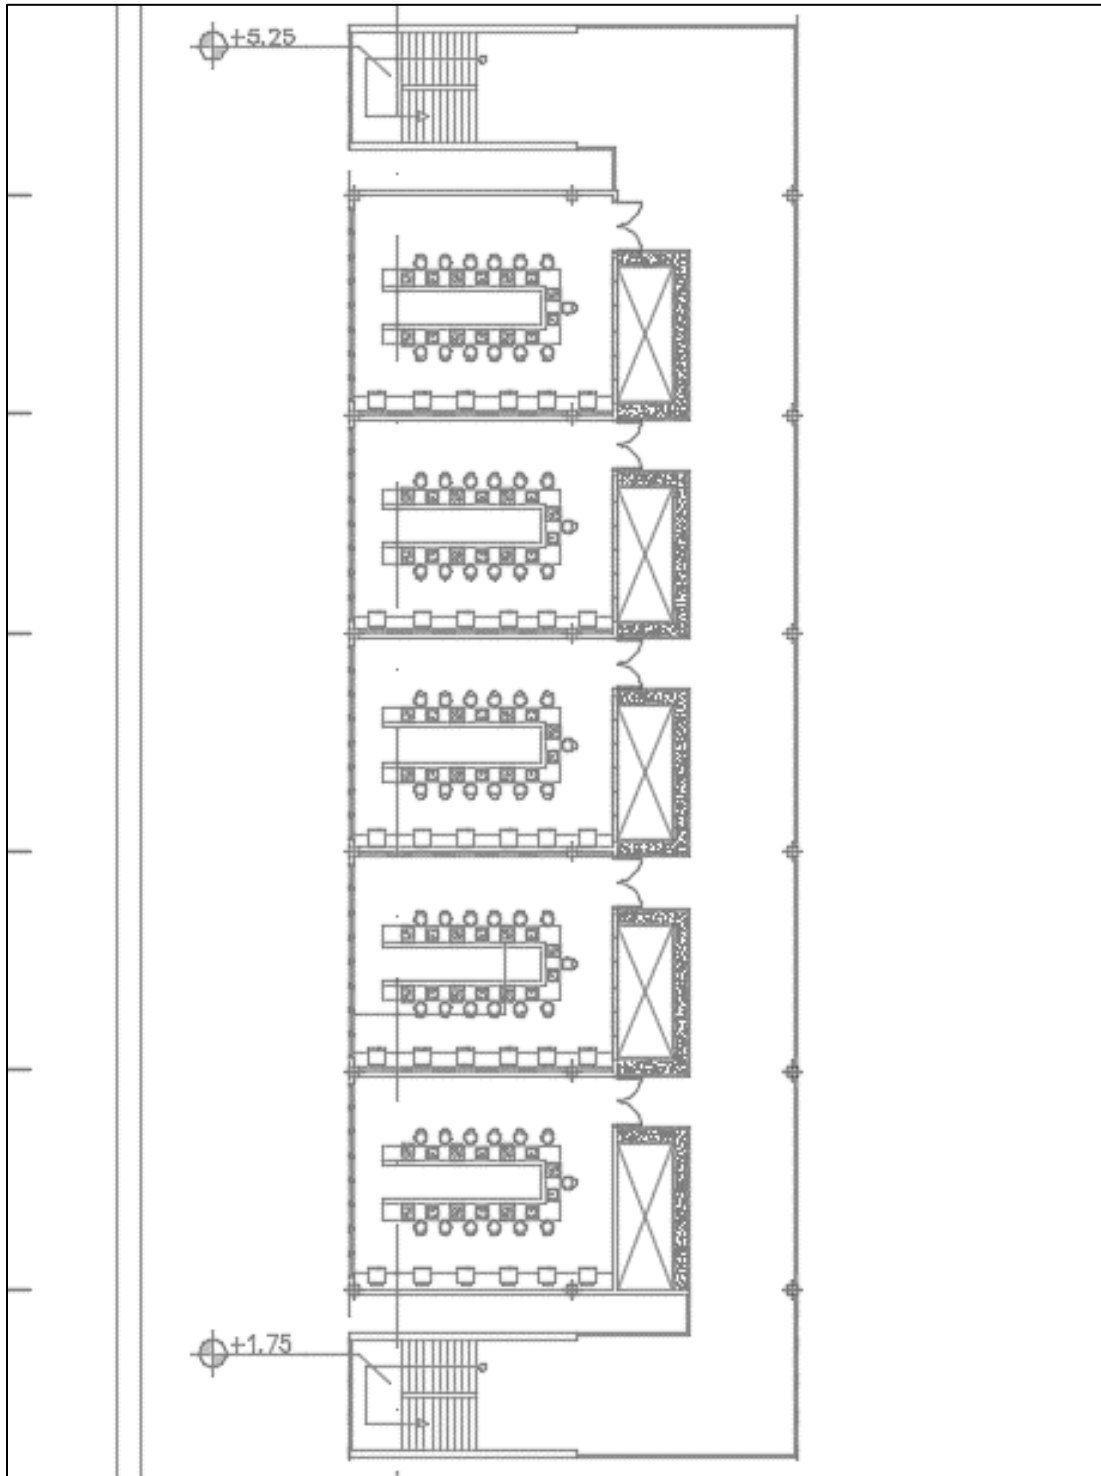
Planta Primer Nivel Módulo Culinario. Fuente: Propia autoría. (2018).
